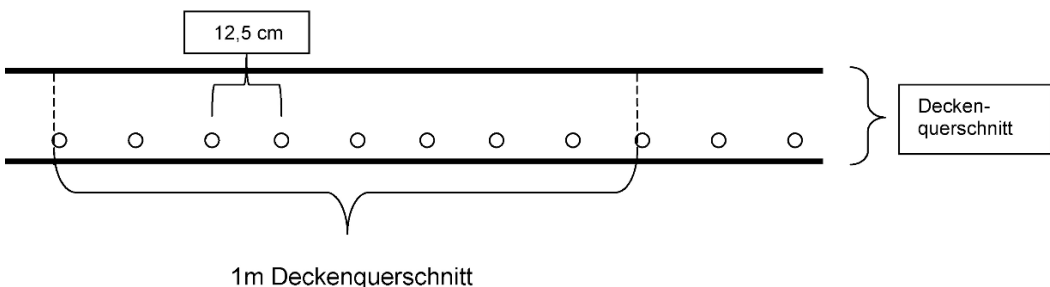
Der 1 m-Schnitt im Stahlbetonteil
